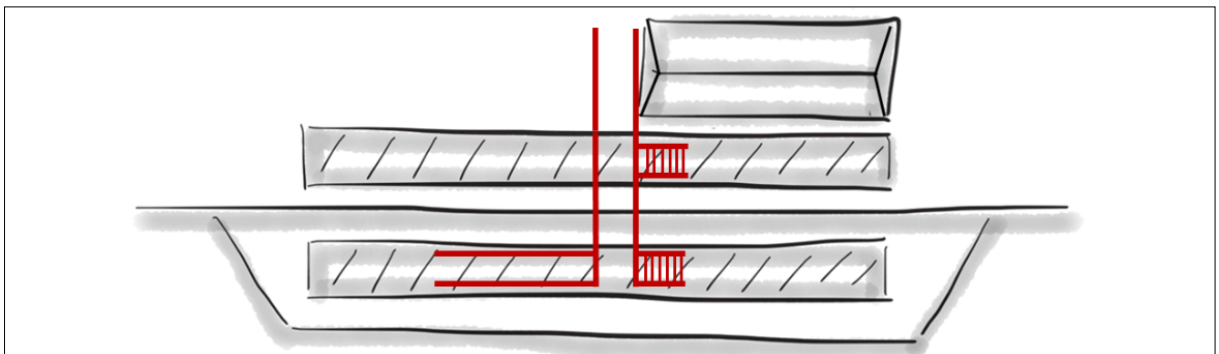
Schéma d'une gare du type M4c Nouveau passage inférieur avec rampe
